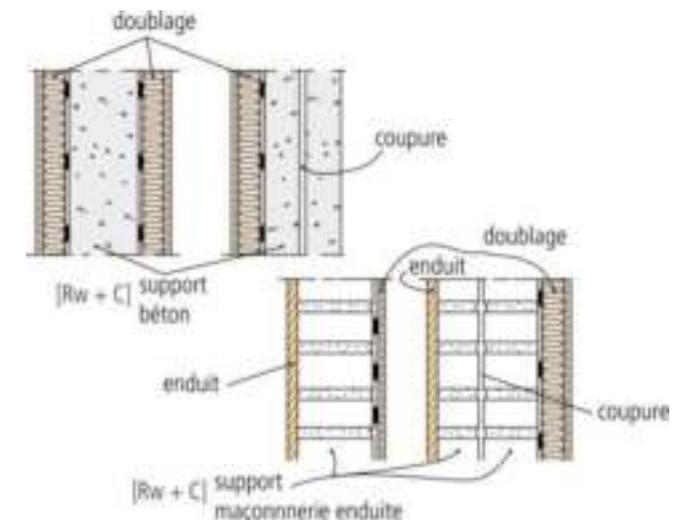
Parois verticales simples ou doubles en béton ou en maçonnerie enduite, recouvertes d'un ou de deux doublages.
